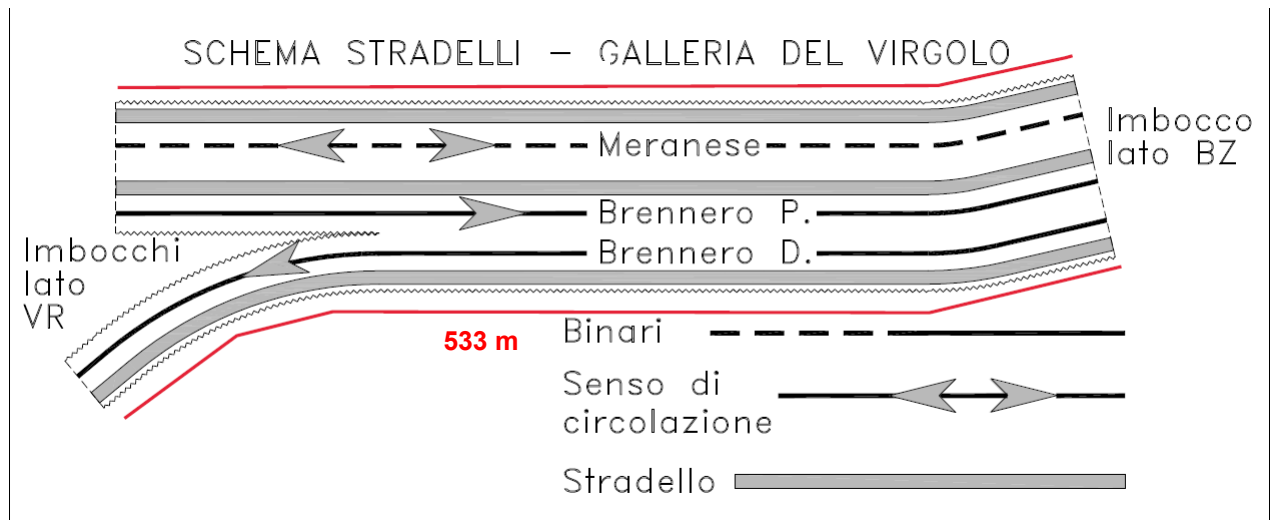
Schema planimetrico della galleria del VirgoLO con indicazione dei marciapiedi
